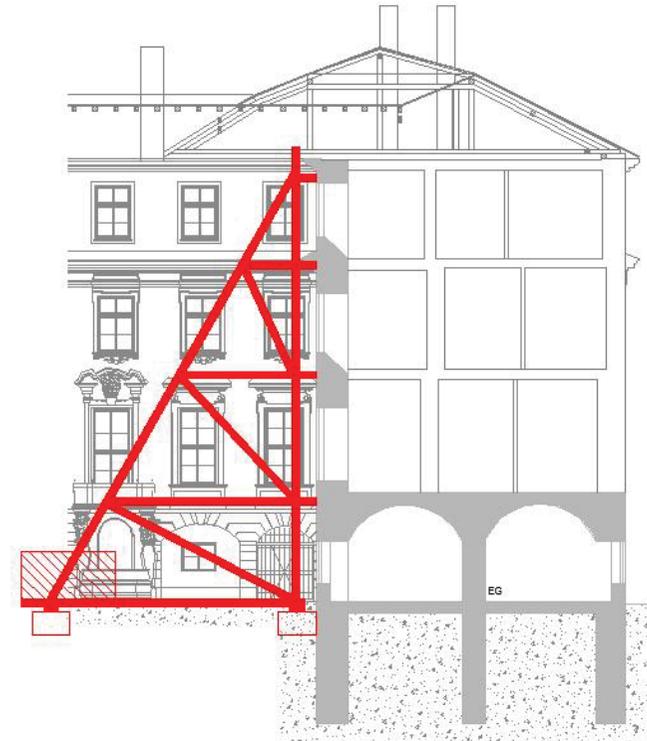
Schema der Stahlkonstruktion zur Sicherung der Innenhofaußenwand im Bauzustand
